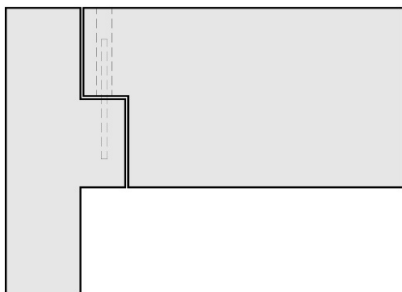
, vista, esquema de apoyo de la viga en el pilar, debe diseñarse el vínculo entre las piezas
